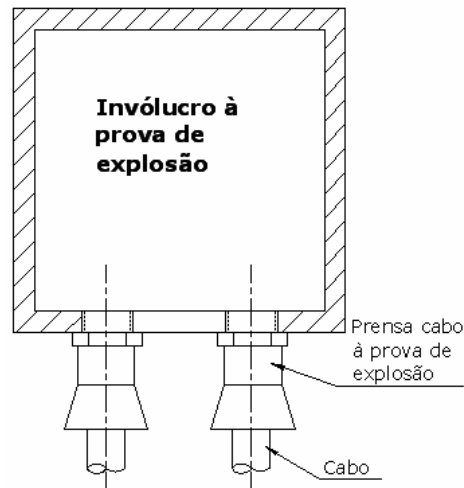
Sistema de Instalação por Cabos com Conexão Direta. Fonte: ABNT, 2006.
